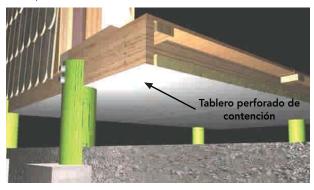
Plataforma de primer piso con aislación térmica. La aislación es sujecionada con tablero perforado para mantener ventilada la estructura.
